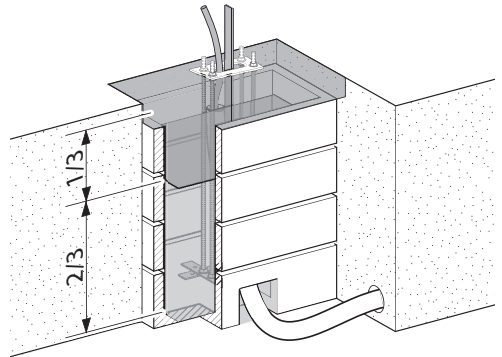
Cementazione delle fondazioni (esempio: AMEDIO®)
